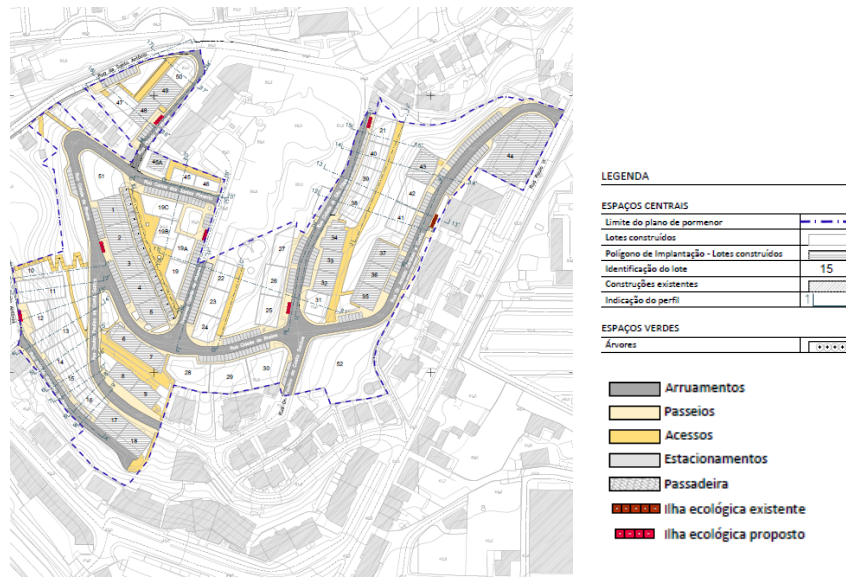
Extrato da Planta da rede viária e localização de ilhas ecológicas da proposta do PPVC
